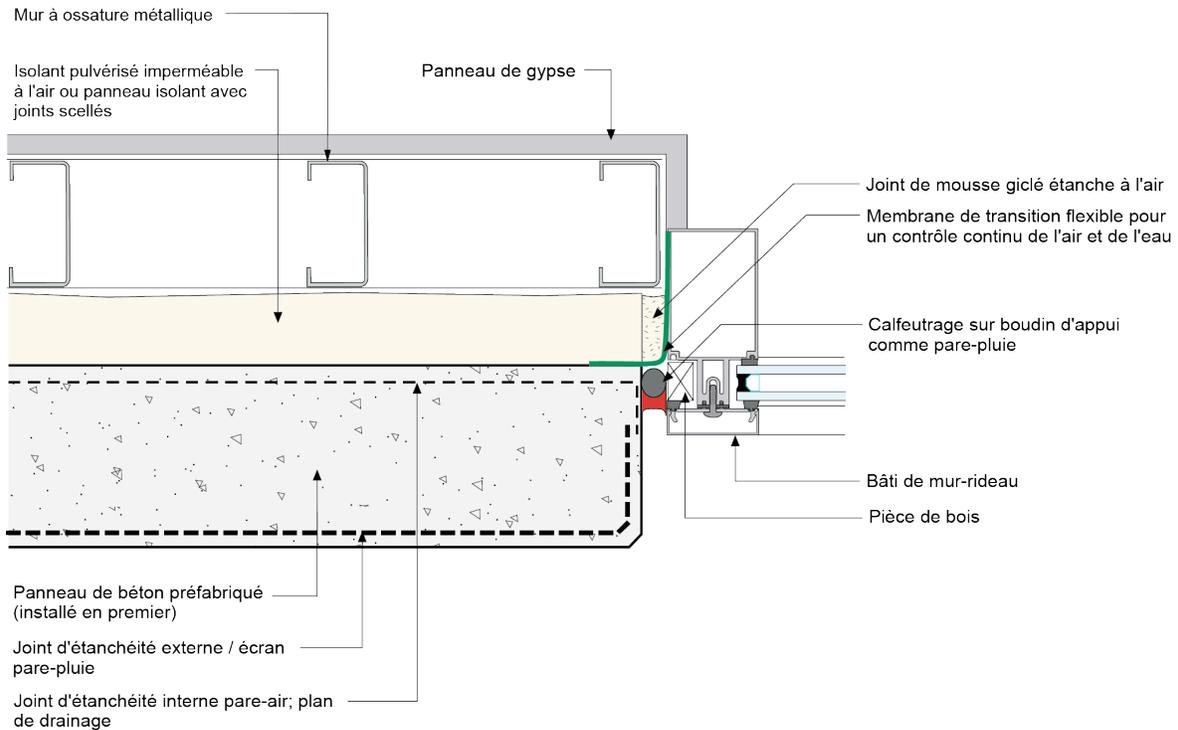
connexion du mur-rideau au montant du béton préfabriqué architectural
